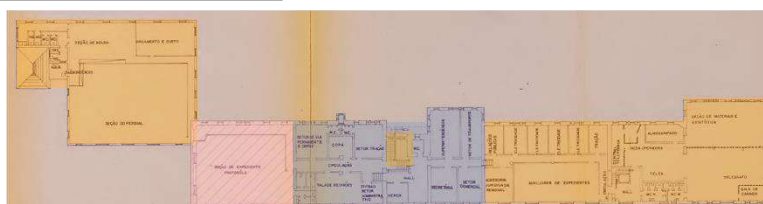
Planta do segundo edifício da estação: destaque da terceira fase construtiva.
